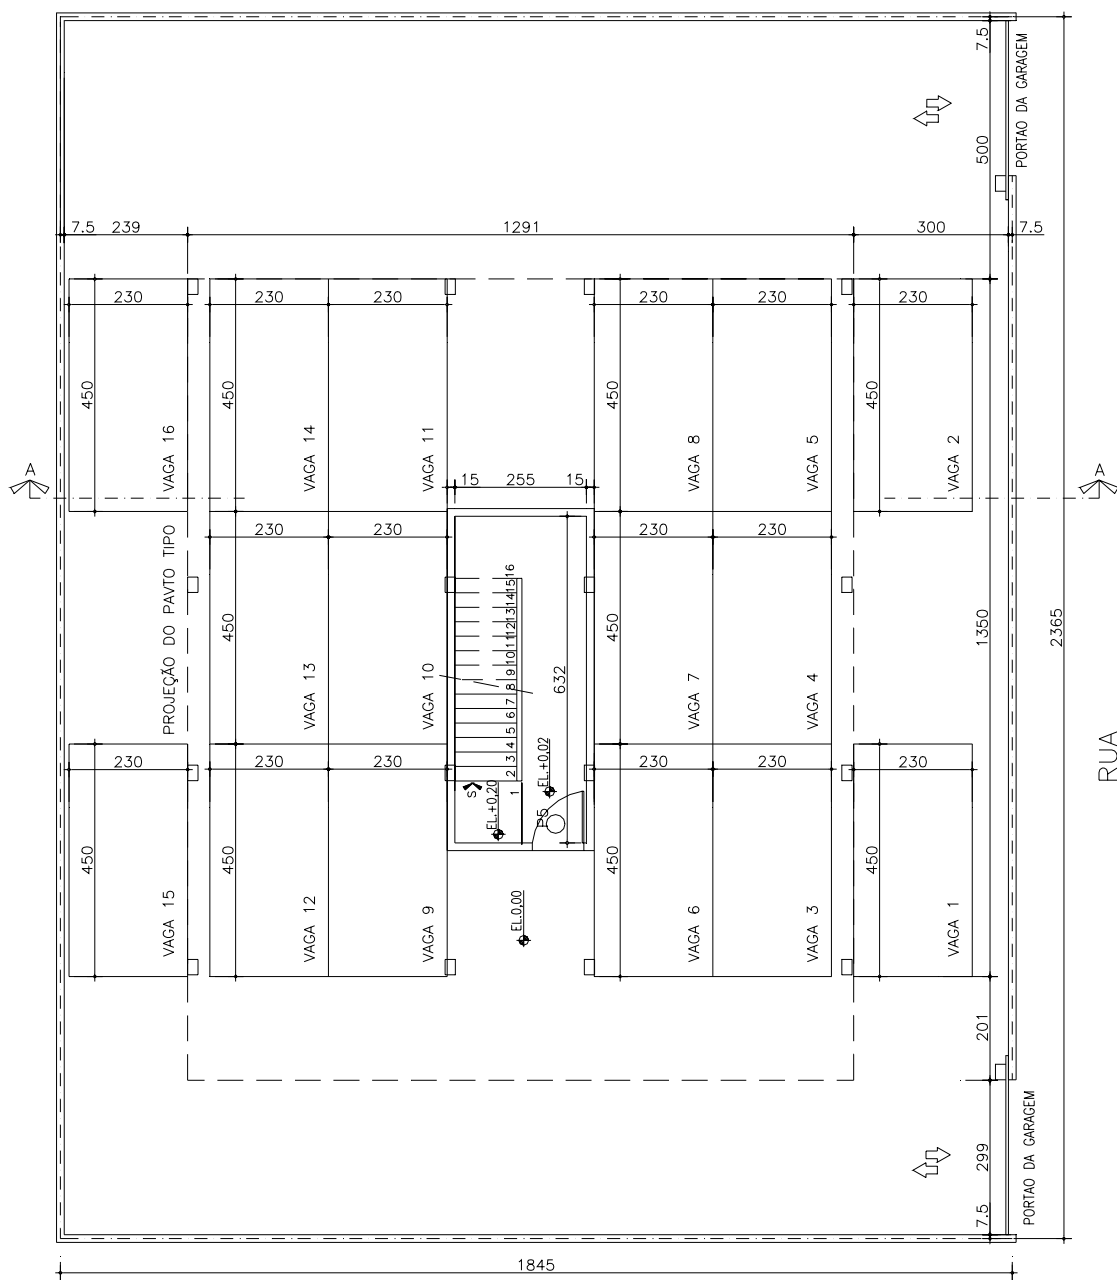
Prédio “M” – Opção 2 – Planta da garagem
